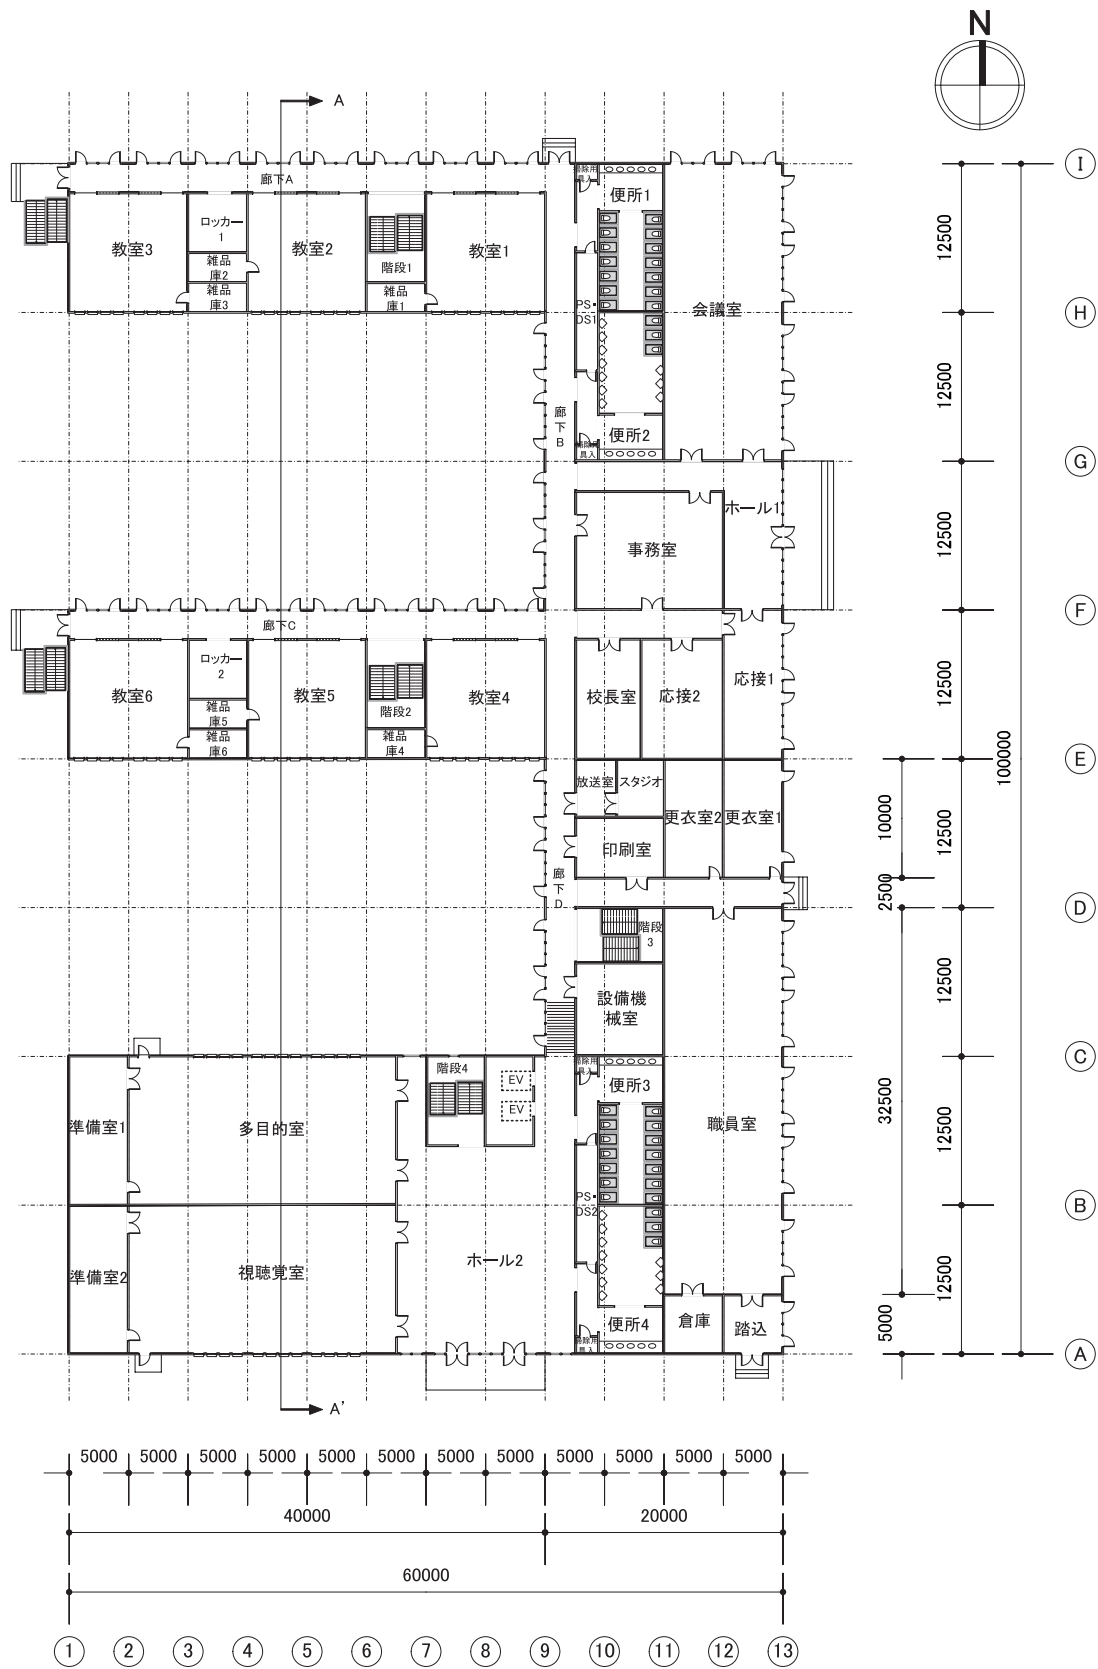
A.20 モデル建物 (学校等・校舎、10,000m<sup>2</sup>) 1階平面図
